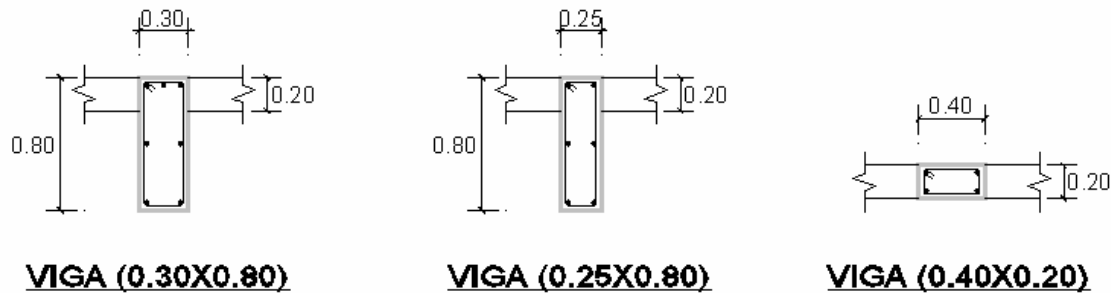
Detalle de vigas de concreto armado (Edificio Gran Unidad Escolar)
